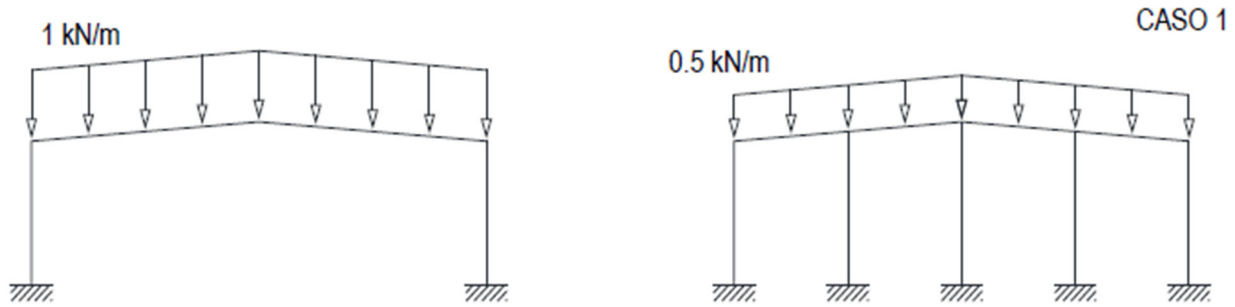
Cargas de nieve para pórtico interior y pórtico de fachada.
